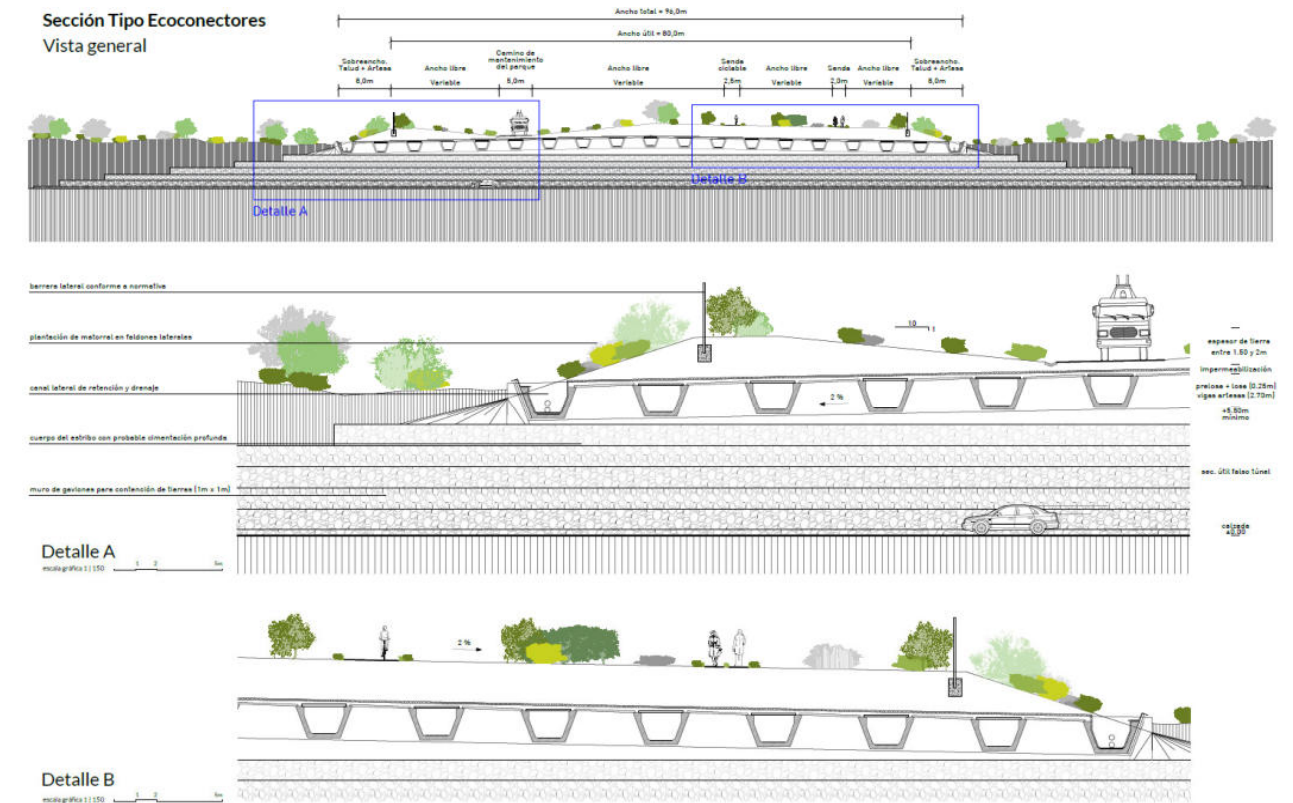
Sección tipo propuesta (predominante) de los Ecoconectores. Tablero de vigas artesas
